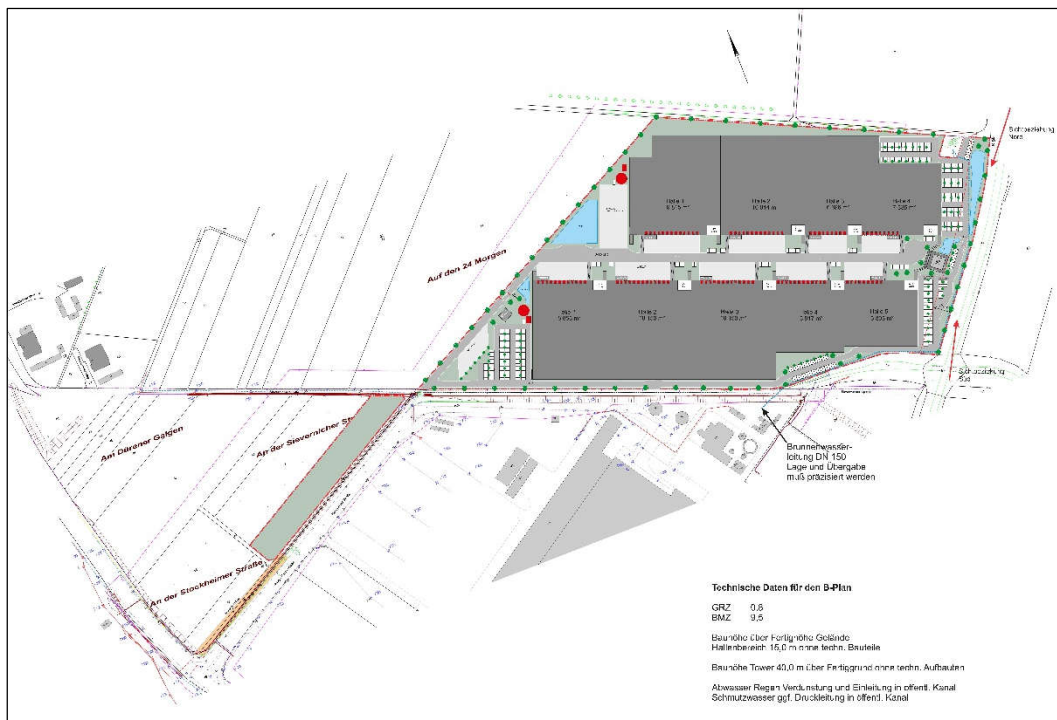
Lageplan des geplanten Gewerbegebiets Henry-Ford-Straße
